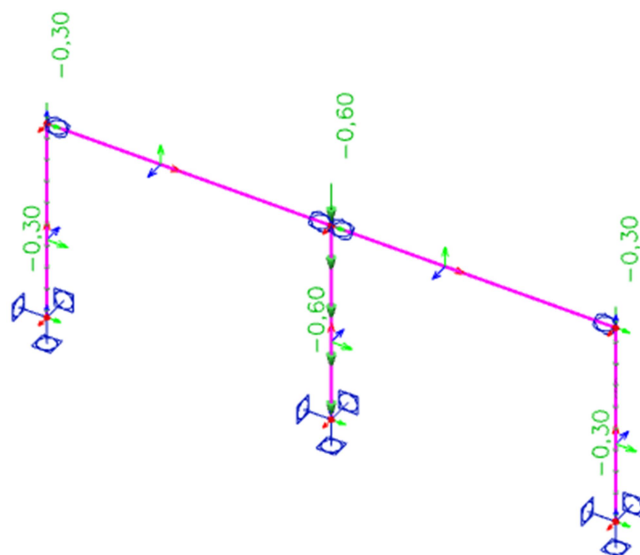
Konstrukce 1, Zatěžovací stav ZS2
